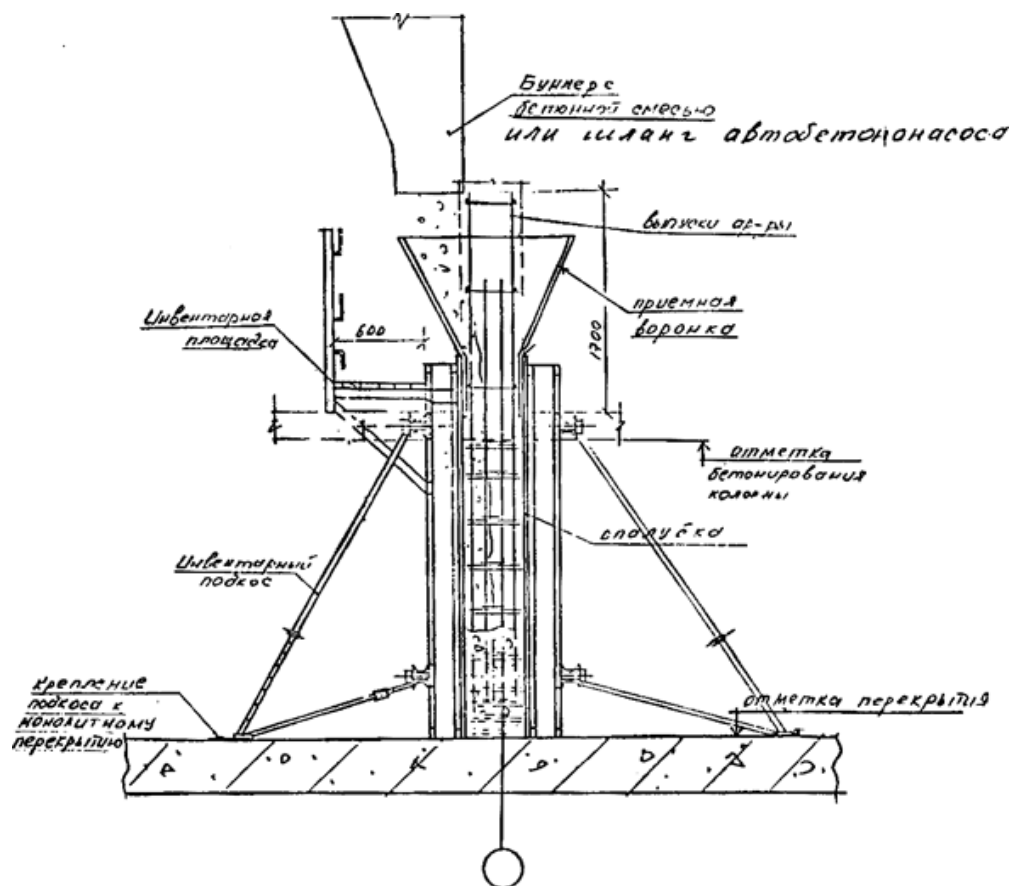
Прием раздаточного поворотного бункера с бетонной смесью
